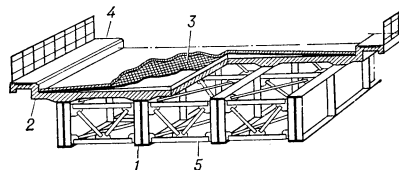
Пролётное строение со сплошными двутавровыми балками: 1 — главные балки; 2 — железобетонная плита проезжей части; 3 — покрытие проезды; 4 — тротуары; 5 — связи.
